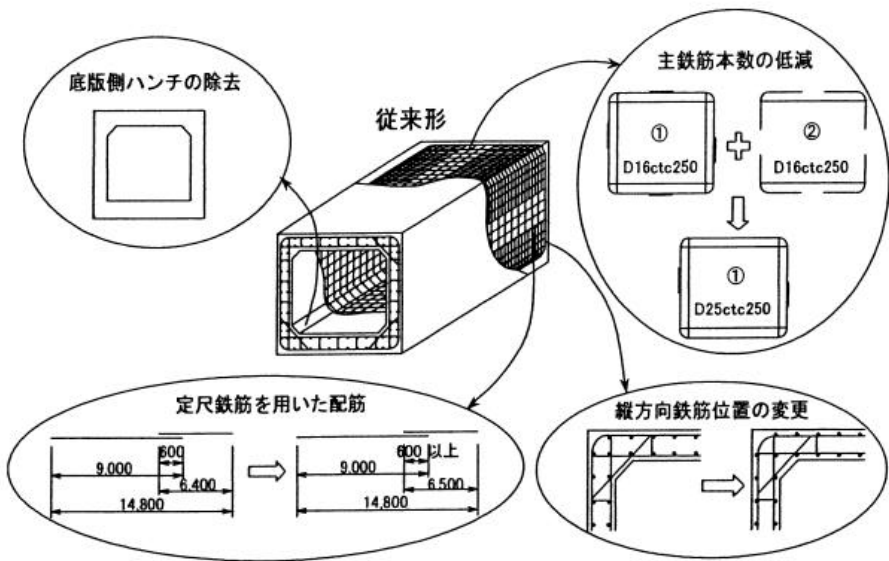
樋門の設計・施工合理化策の概要図（函渠）
